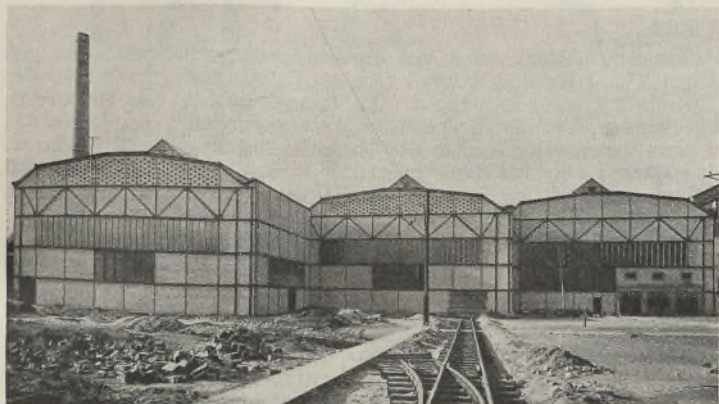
Ansicht der Ofen- und neuen Walzwerkhallen.
